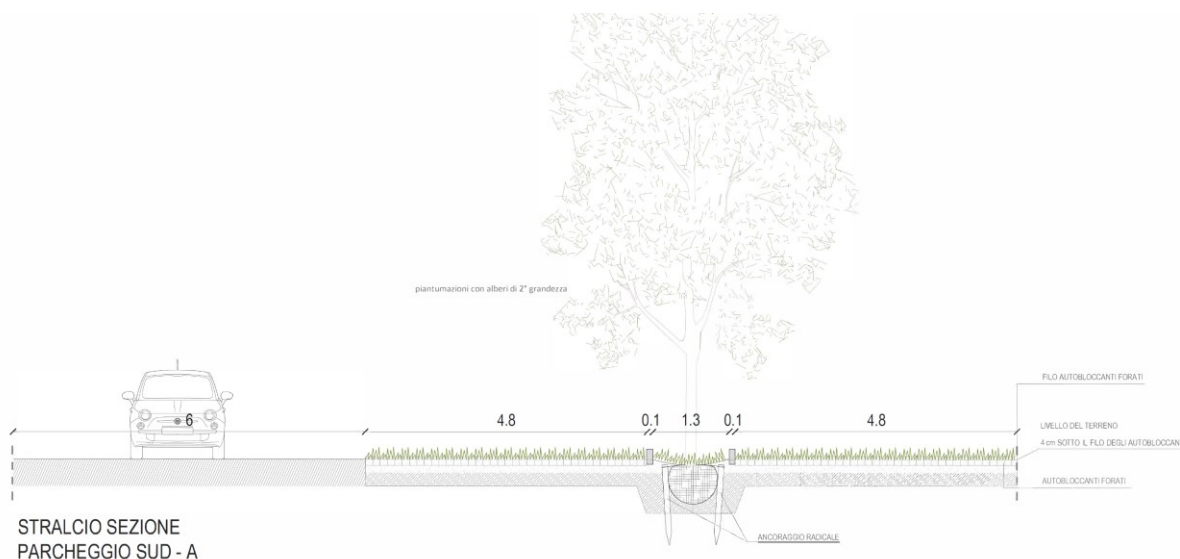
Stralcio sezione parcheggio nord - – Progetto oggetto della procedura di Verifica di VIA
